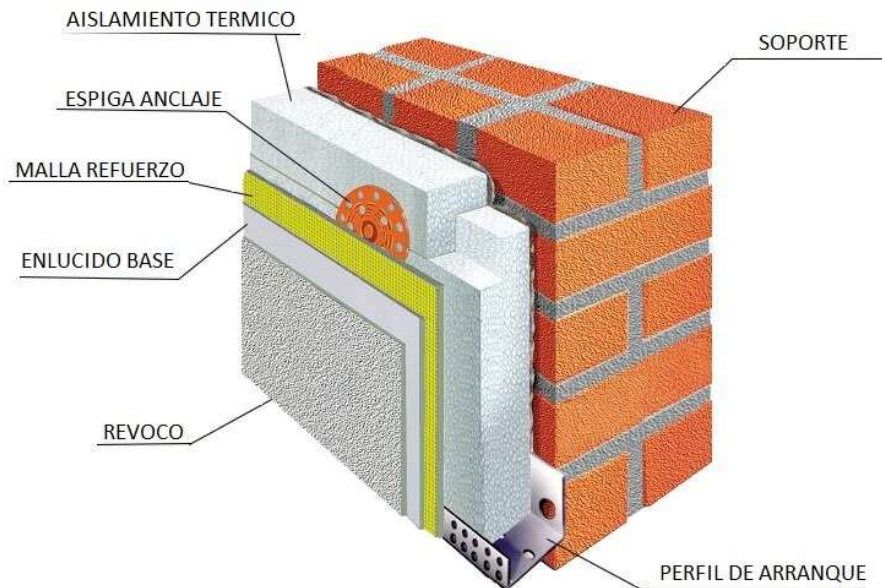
Detalle de ensamble sistema de fachada SATE
